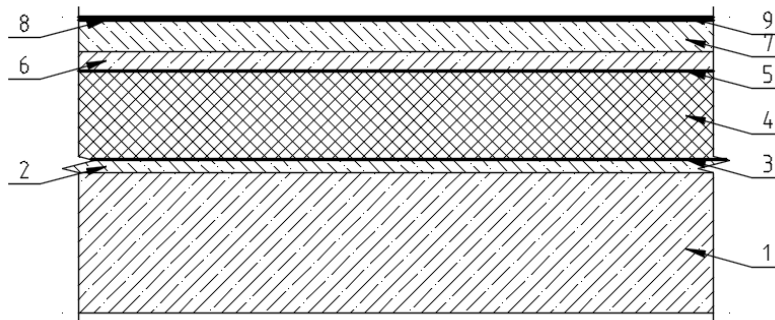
Схема покрытия неэксплуатируемой кровли
